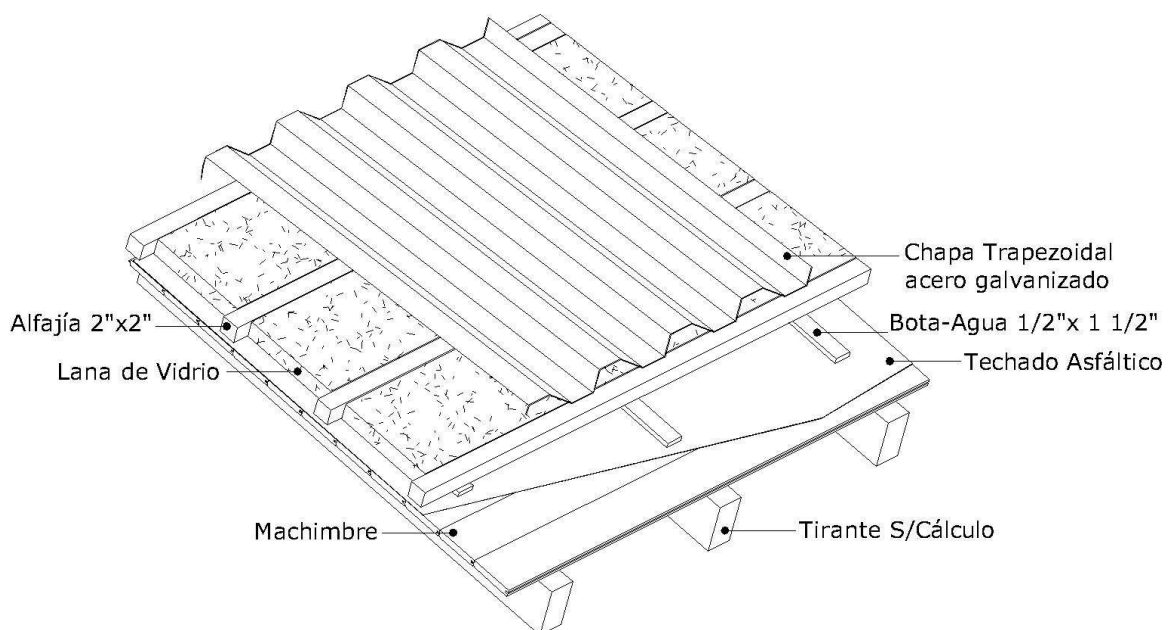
Cubierta de chapa galvanizada trapezoidal tipo T-98, montada sobre tirantería de madera con cielorraso de madera machiembreada de 25 mm de espesor, fieltro asfáltico impermeabilizante, bota-aguas, aislamiento térmico constituida por fieltro de lana de vidrio de 30 mm de espesor.
